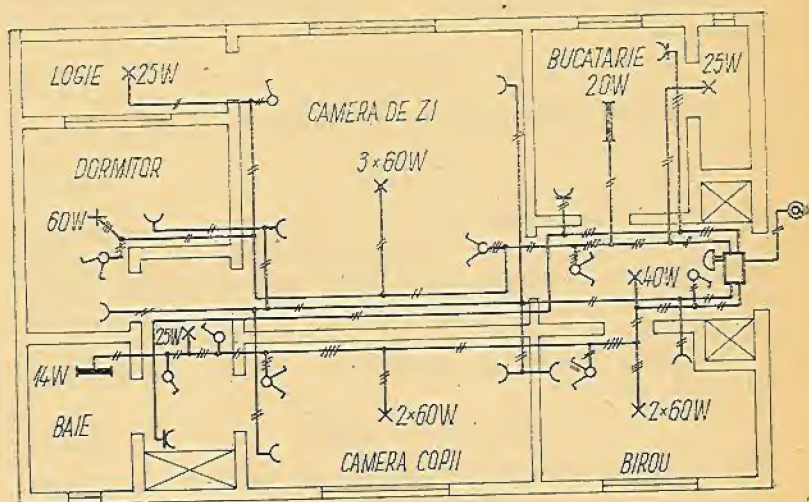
Planul și schema instalației electrice de iluminat și prize ale unui apartament.
